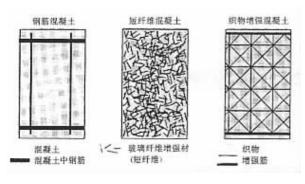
钢筋混凝土 纤维混凝土 , 织物混凝土构件断面示意图
